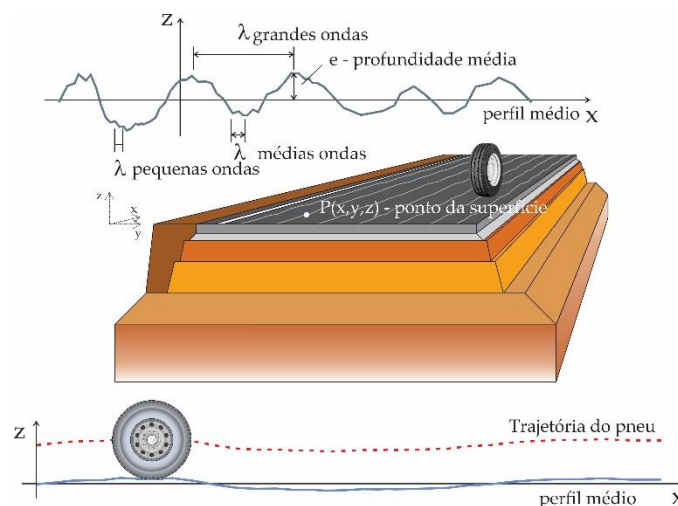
Perfil longitudinal e transversal de um pavimento e a trajetória de um pneu
